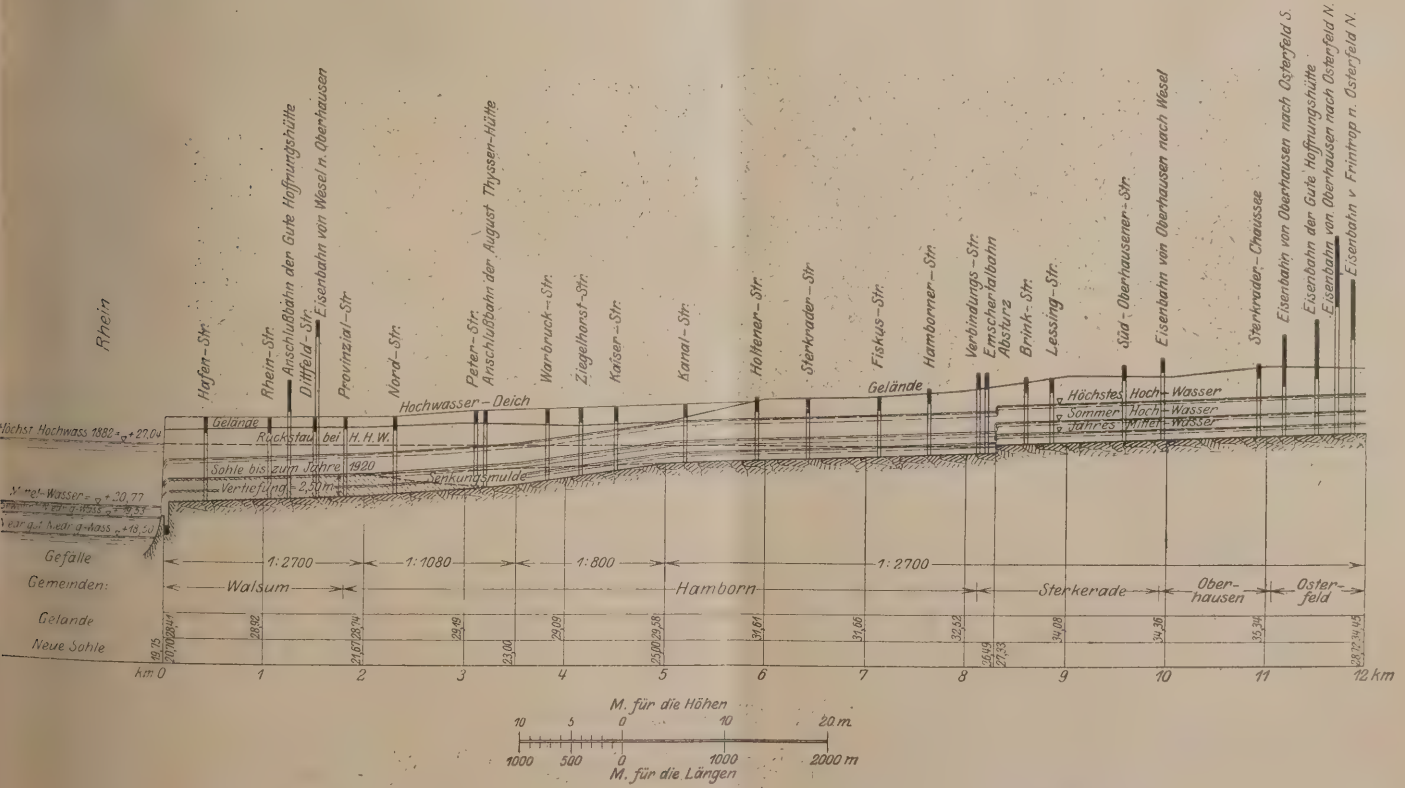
Längenschnitt durch die Mündungsstrecke der neuen Emscher vom Rhein bis Oberhausen.
